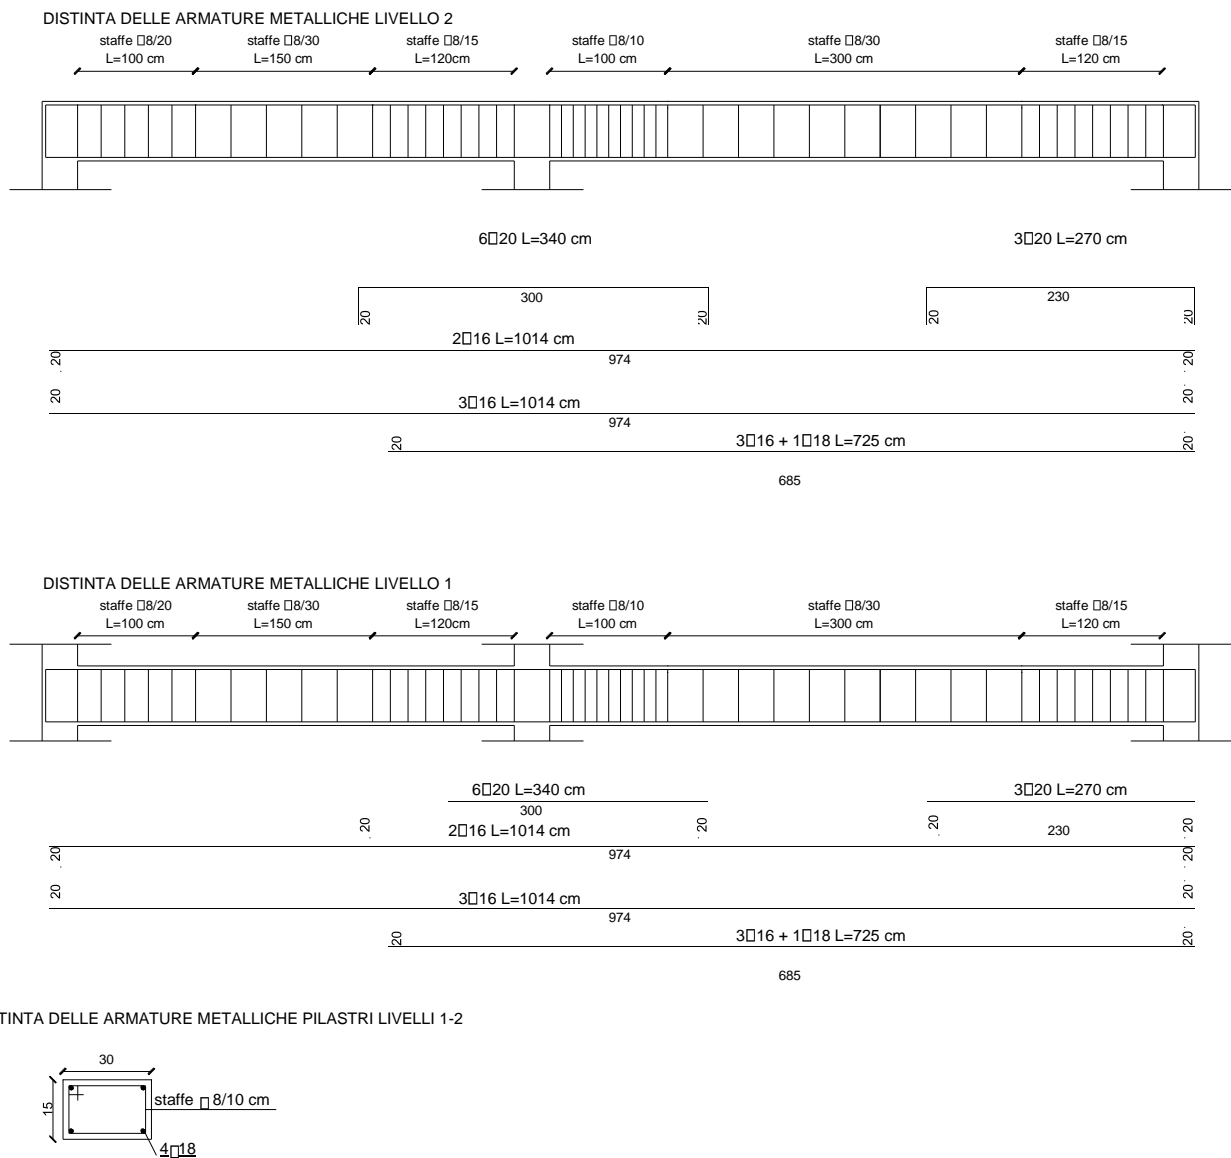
Distinta delle armature degli elementi strutturali.
